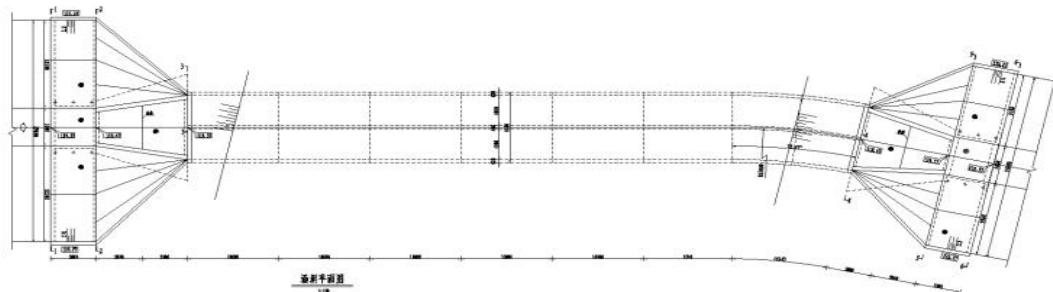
郑州航空实验区段大马村沟 1#涵洞平面图
